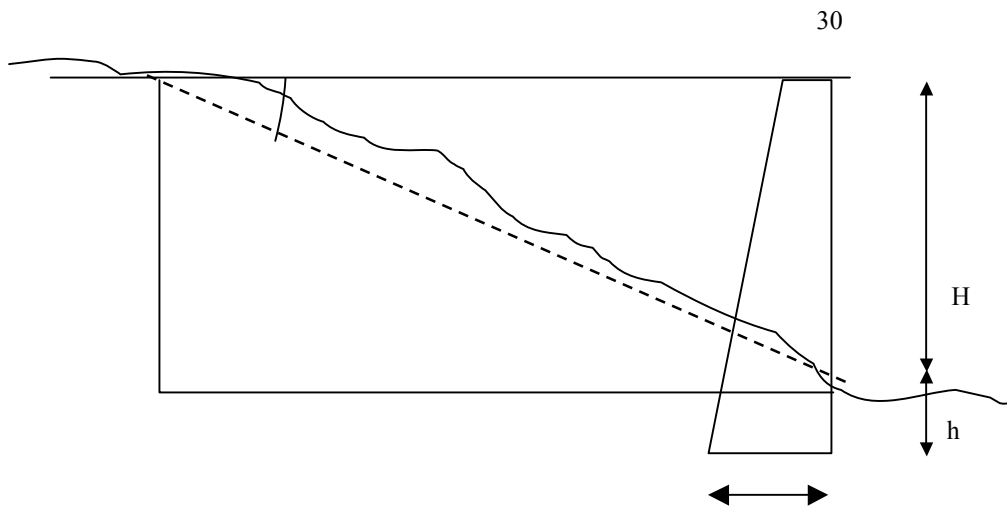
Predimensionamiento de un muro de contención de mampostería.
